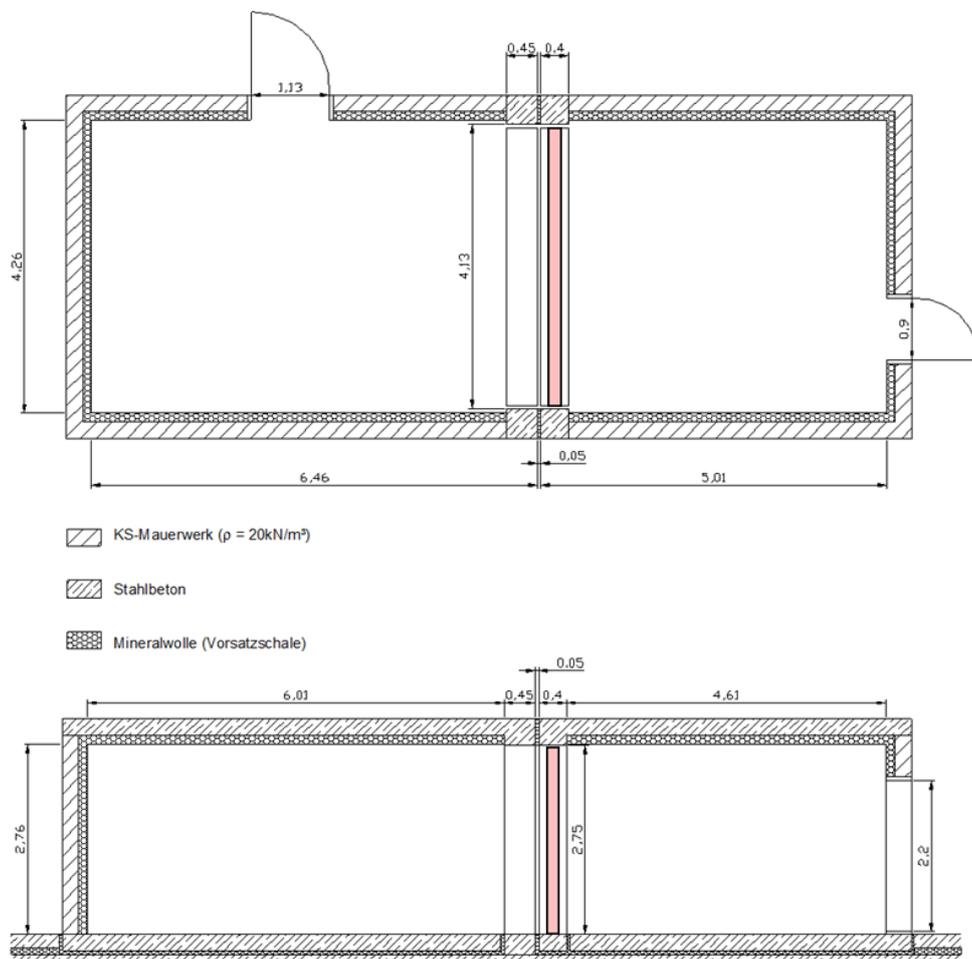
Grundriss und Schnitt (ohne Maßstab) des Wandprüfstandes mit Einbauposition der Metallständer-Montagewände (rot)
